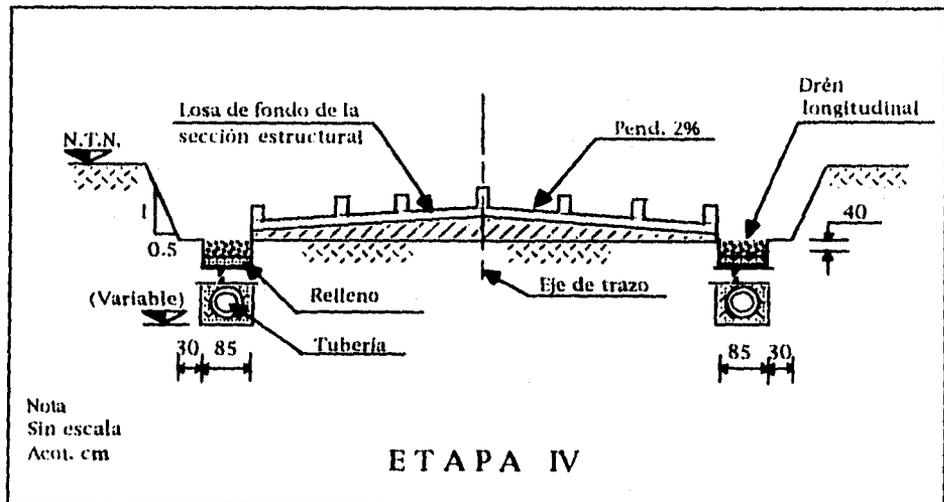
ETAPA IV Armado y colado de la losa de fondo
